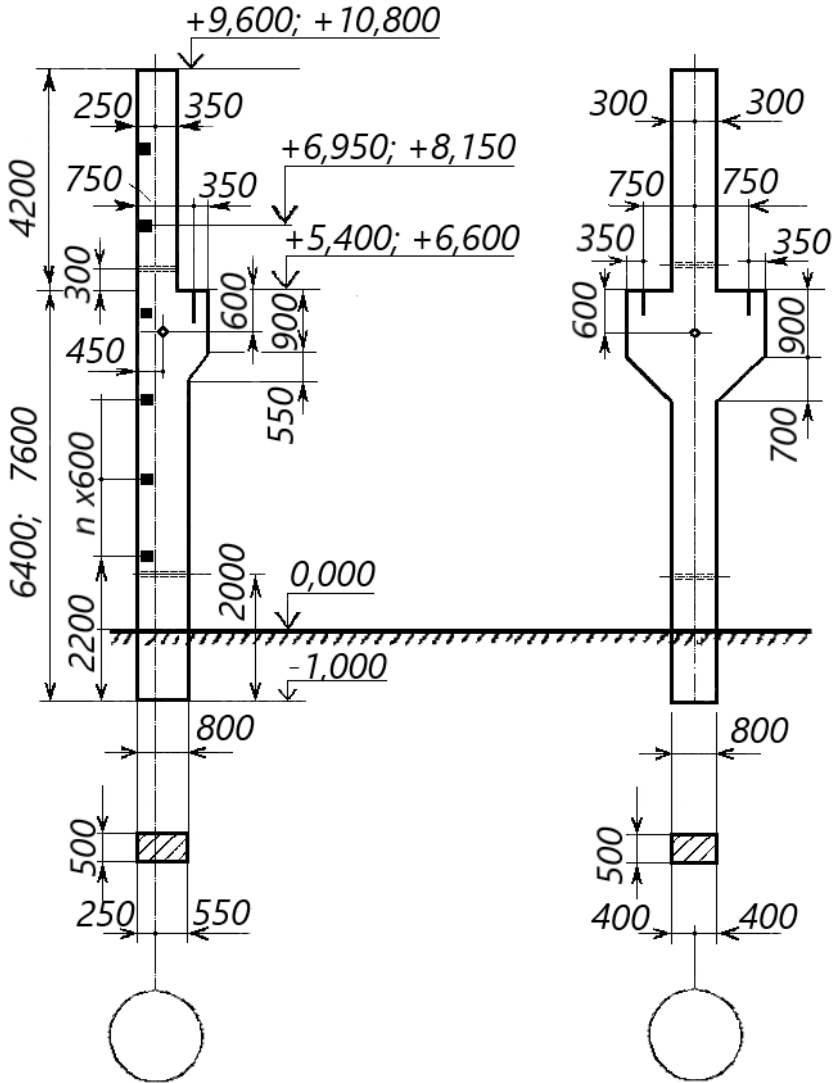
Типові колони для будівель висотою 9,6 м або 10,8 м з кранами вантажністю 100 кН або 200/50 кН, прольотами 18 м або 24 м, з кроком колон 12 м
